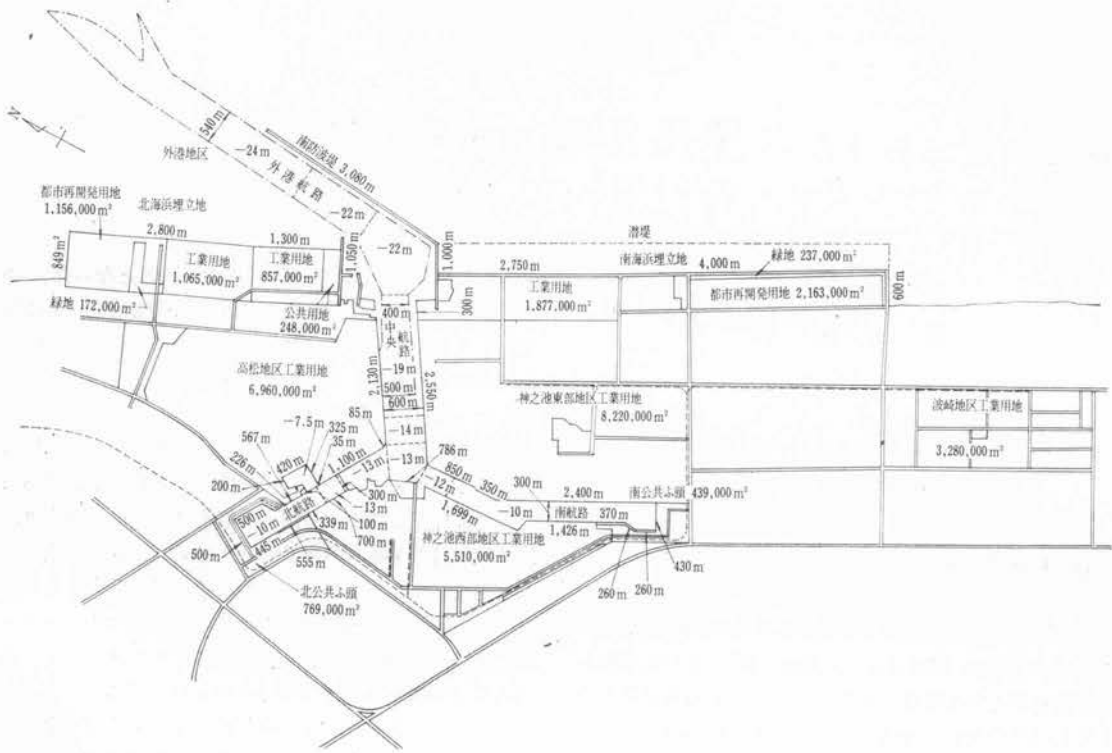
鹿島港港湾計画平面図 (昭和 47 年 12 月)
